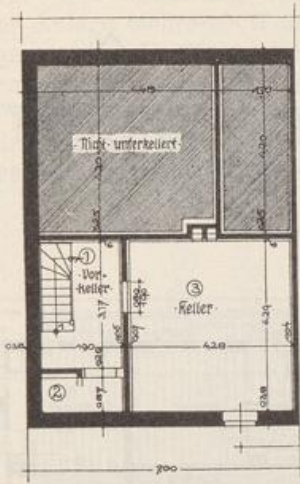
Grundriß zu Abb. 80. Kellergeschoß, linke Hälfte.
